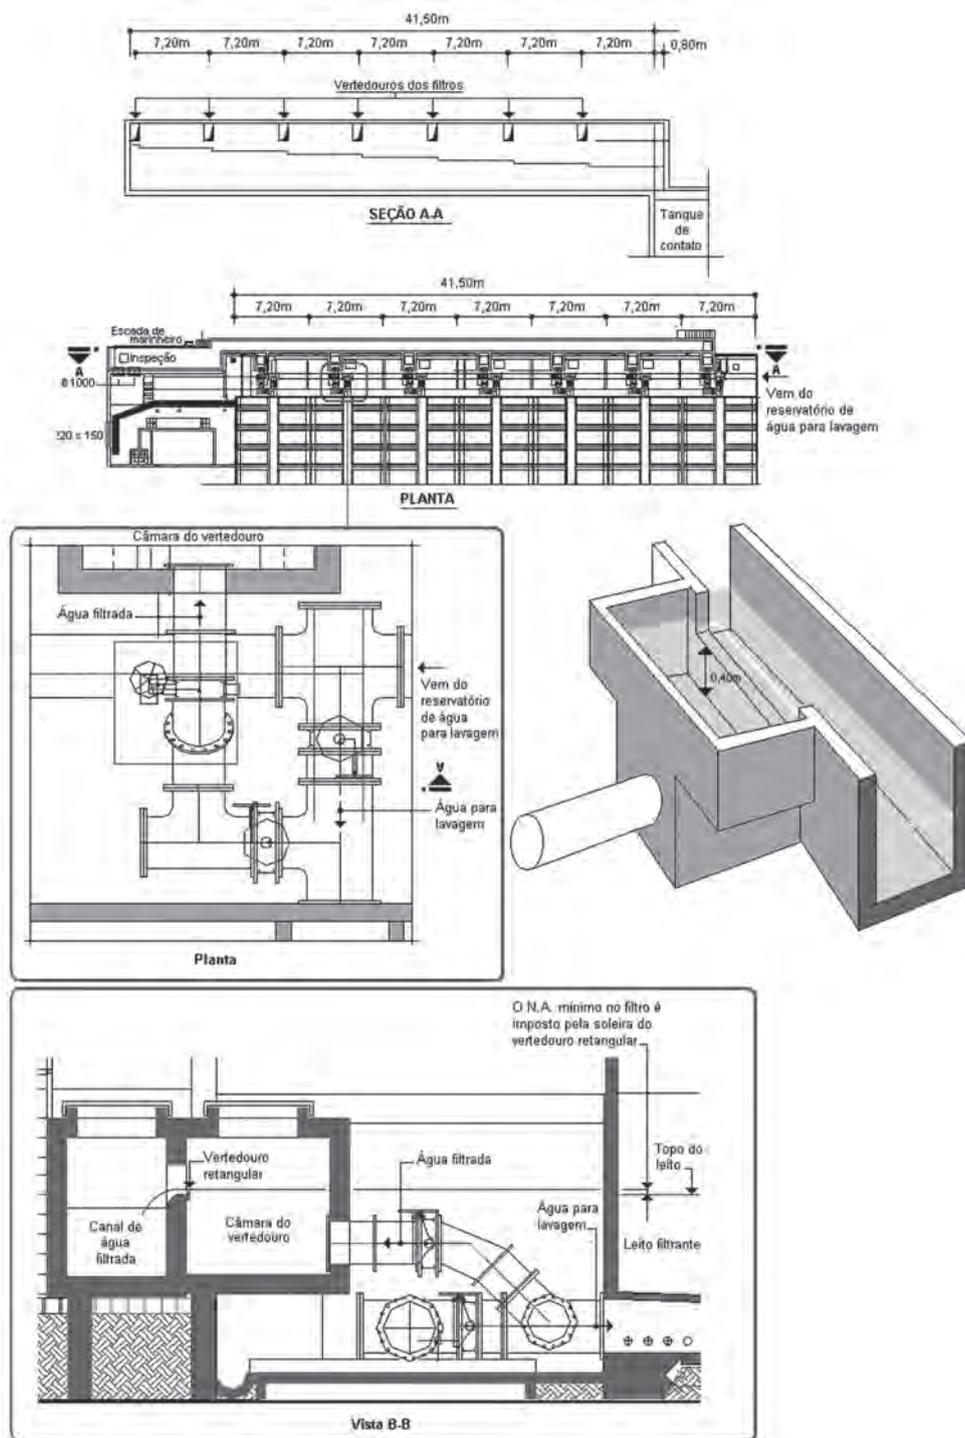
Canal de água filtrada, após a reforma: planta, vista e detalhe em perspectiva.
